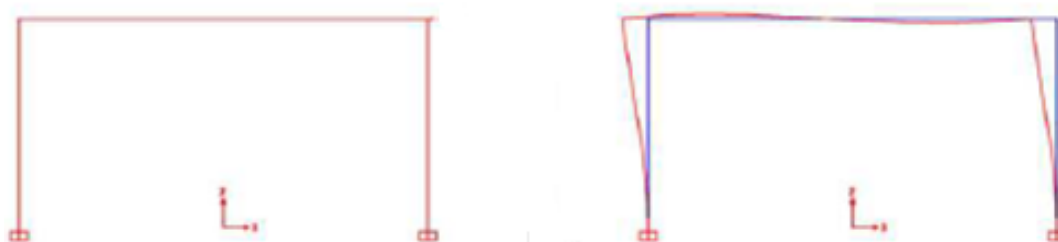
Aplicação do carregamento manual e deformada do modelo plano
